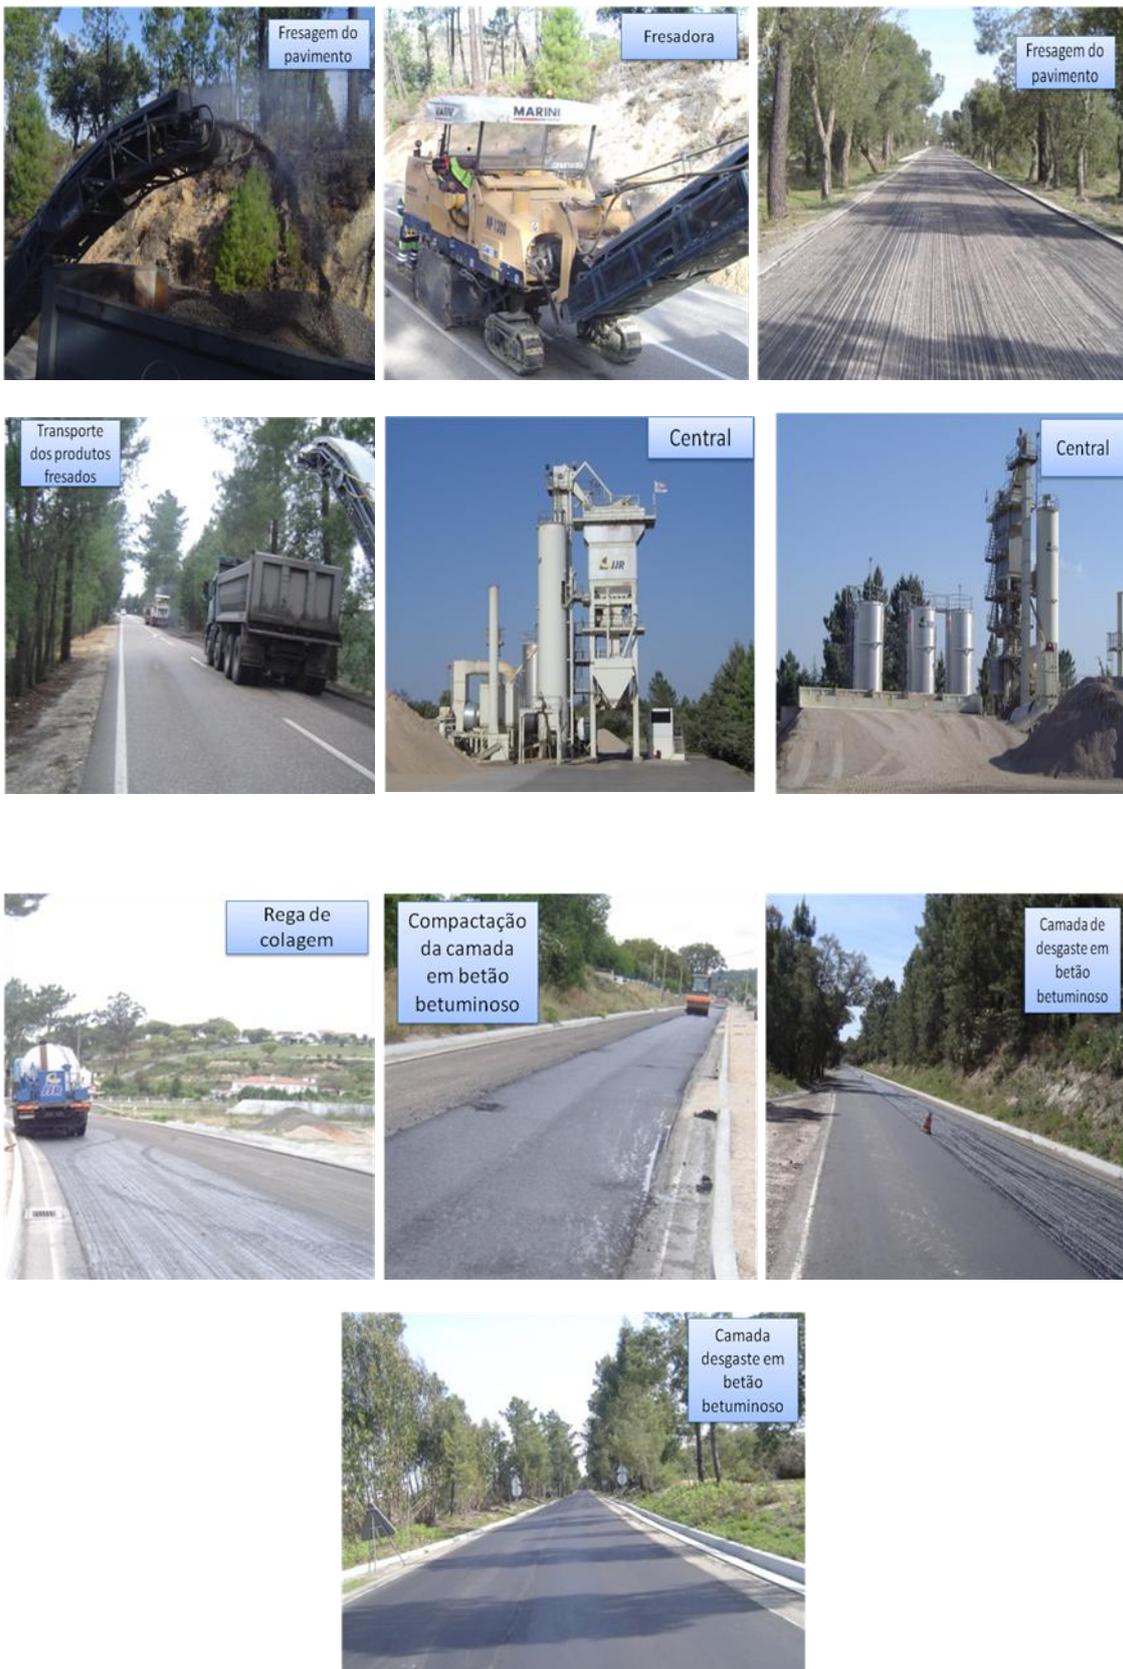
Processo construtivo – reciclagem de pavimentos em central
